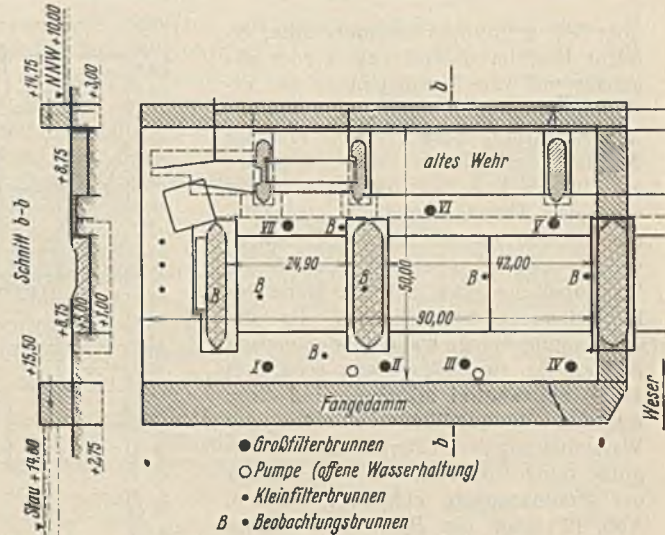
Brunnenanlage im zweiten Bauabschnitt.
